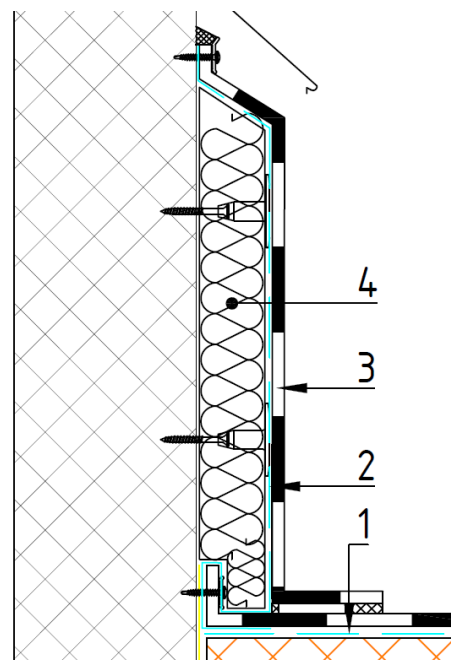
Схема устройства электропроводящего слоя на парапете с теплоизоляцией
